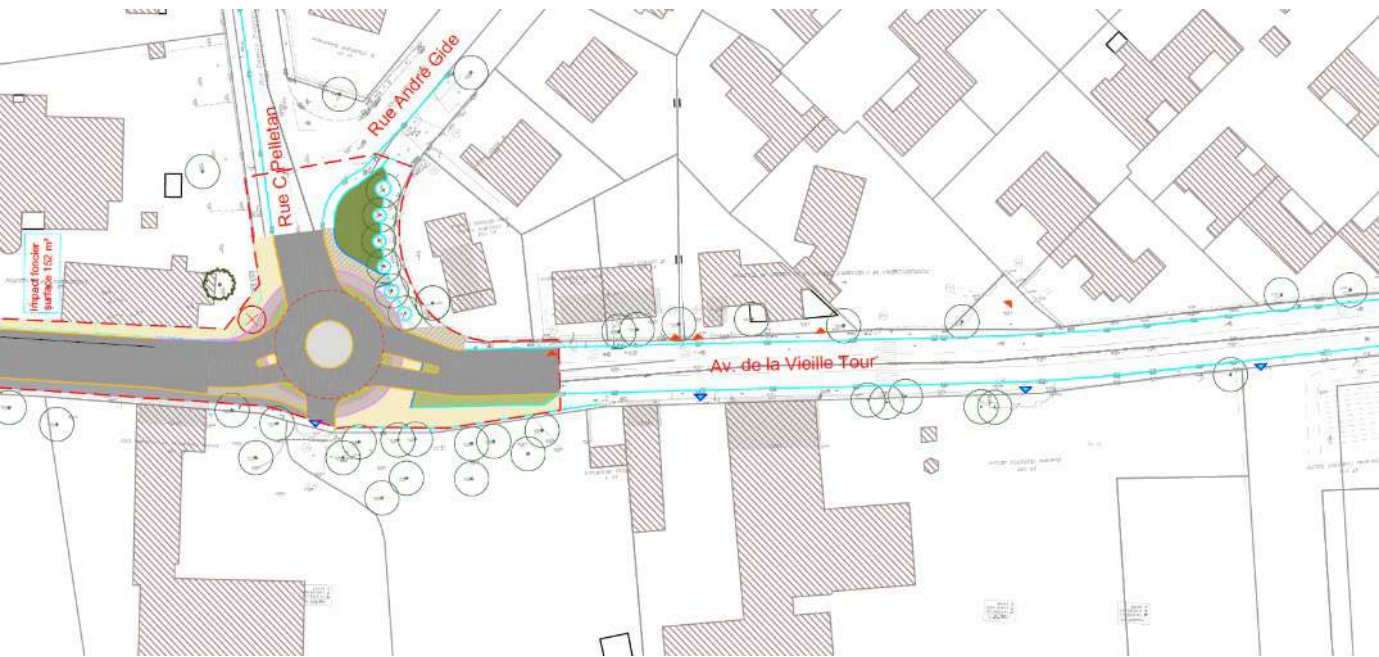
Plan AVP de l'avenue de la Vieille Tour
